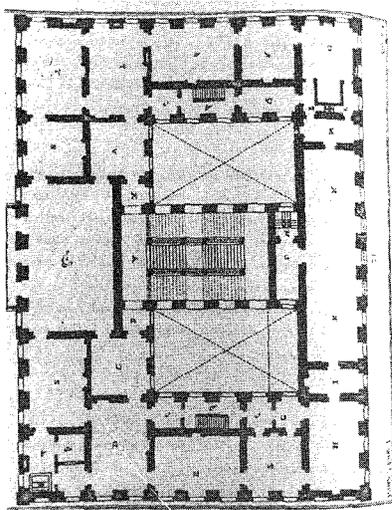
Bails, Disposición de planta para una vivienda Aristócrata (1796).
